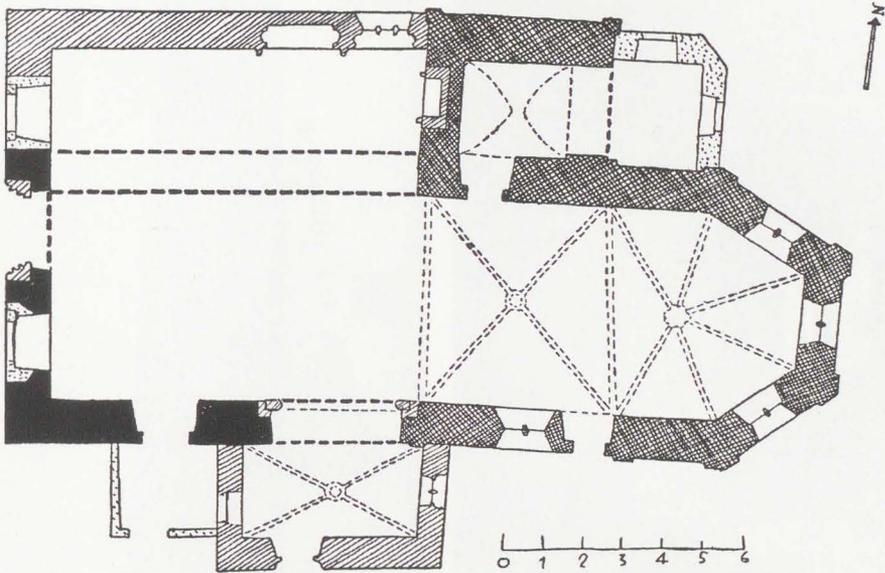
Grundriss von Eduard Krüger (aus: E. Krüger: Schwäbisch Hall mit Großkomburg, Steinbach und Limpurg, Schwäbisch Hall 1953)
